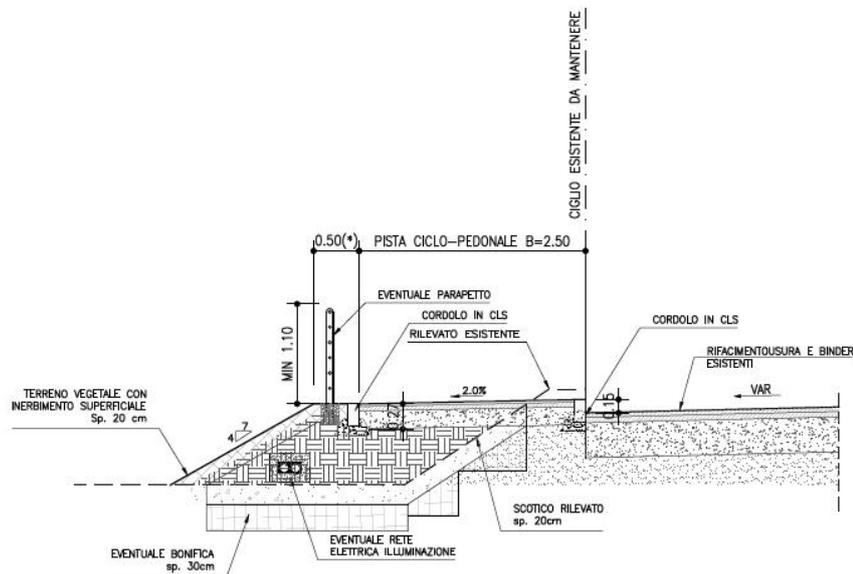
Sezione Tipo pista ciclabile in sede propria con cordolo insormontabile
